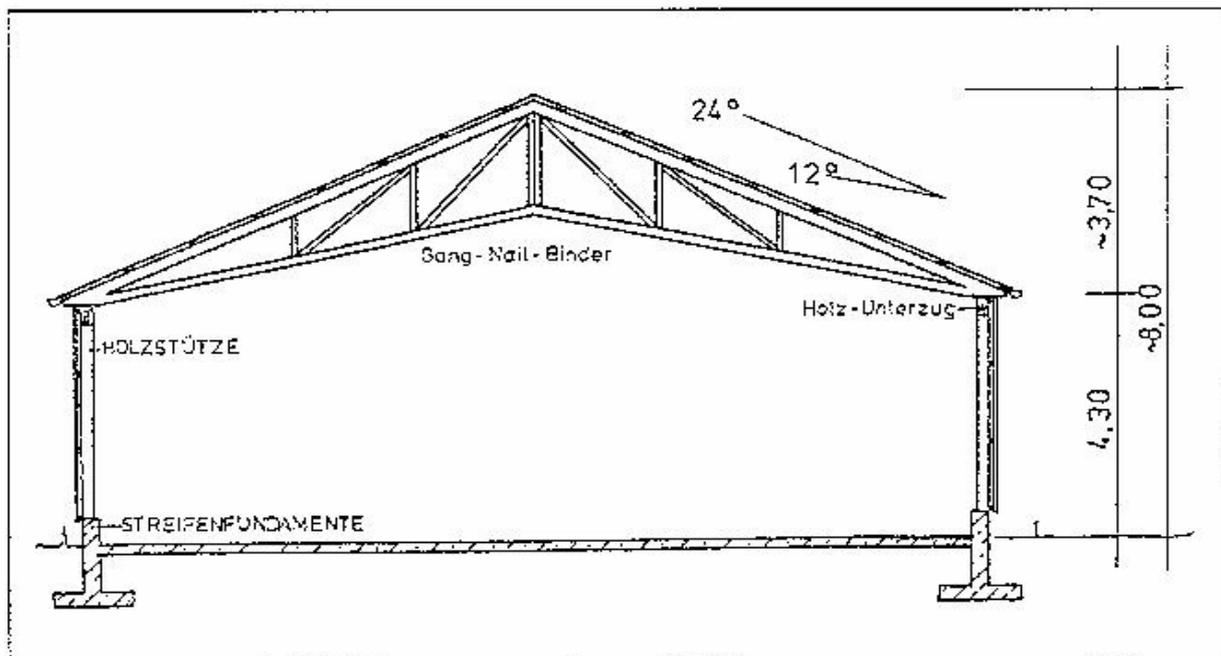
Holz-Gang-Nail- Halle (Werkbild Landbau Schwarz GmbH)
